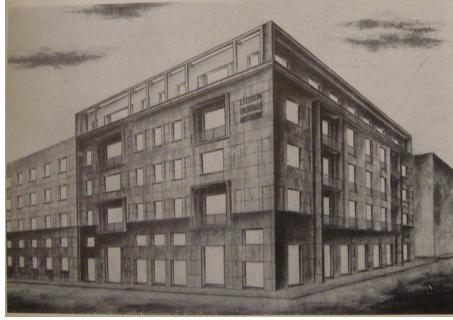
Palazzo dell' I.N.A. ad Enna: II° progetto (stesura definitiva 1939-40)-prospetto anteriore.
